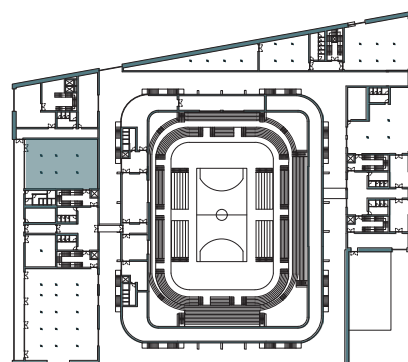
Pianta piano secondo e individuazione uffici caso studio
